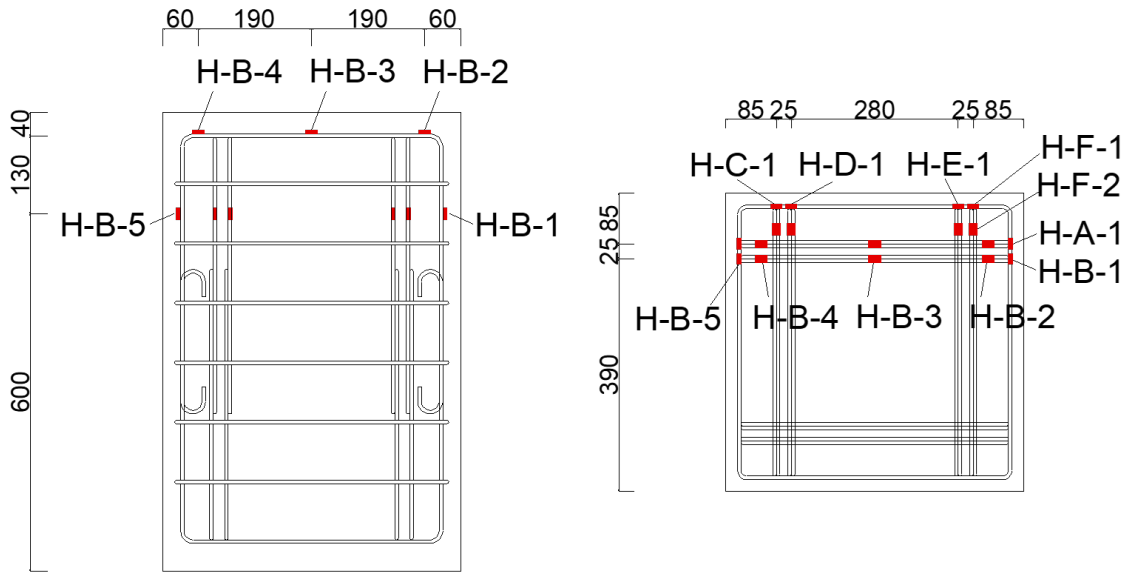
袴筋ゲージ貼付位置 (A-1, B-1, C-1, C-3)
